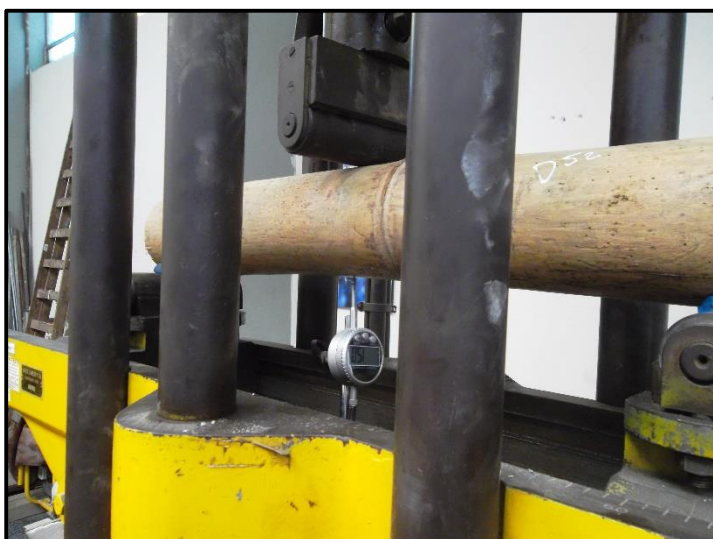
Deformímetro empleado en el ensayo de flexión.
